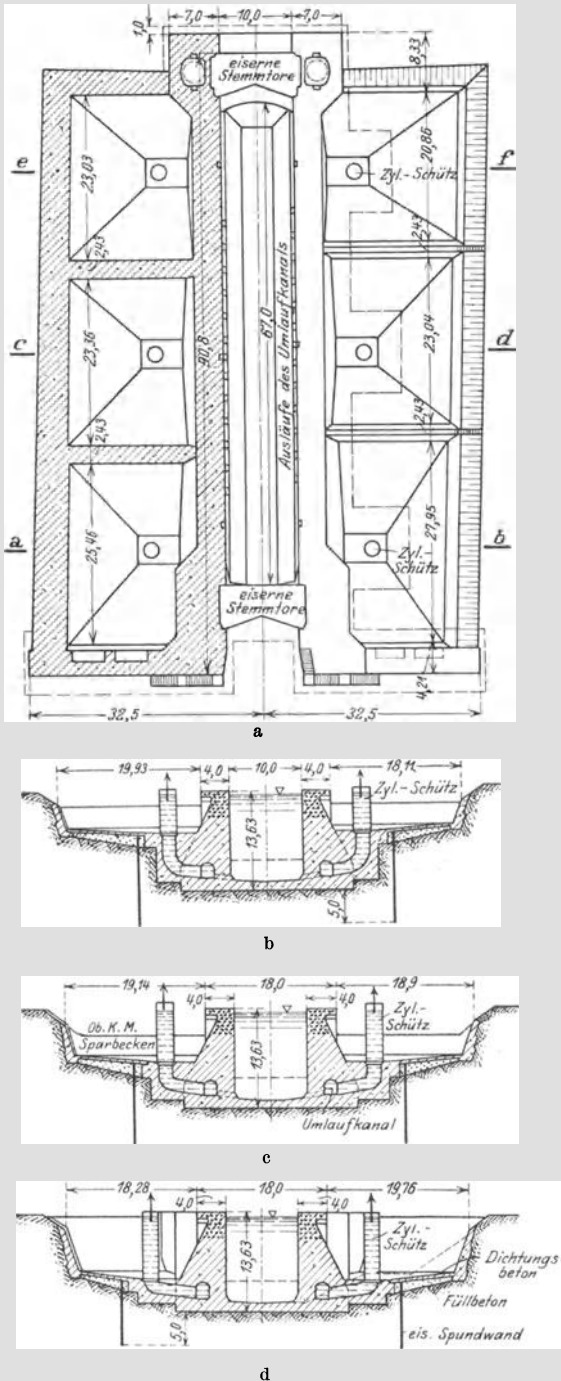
a–d. Sparschleuse Niederfinow mit offenem Sparbecken.
